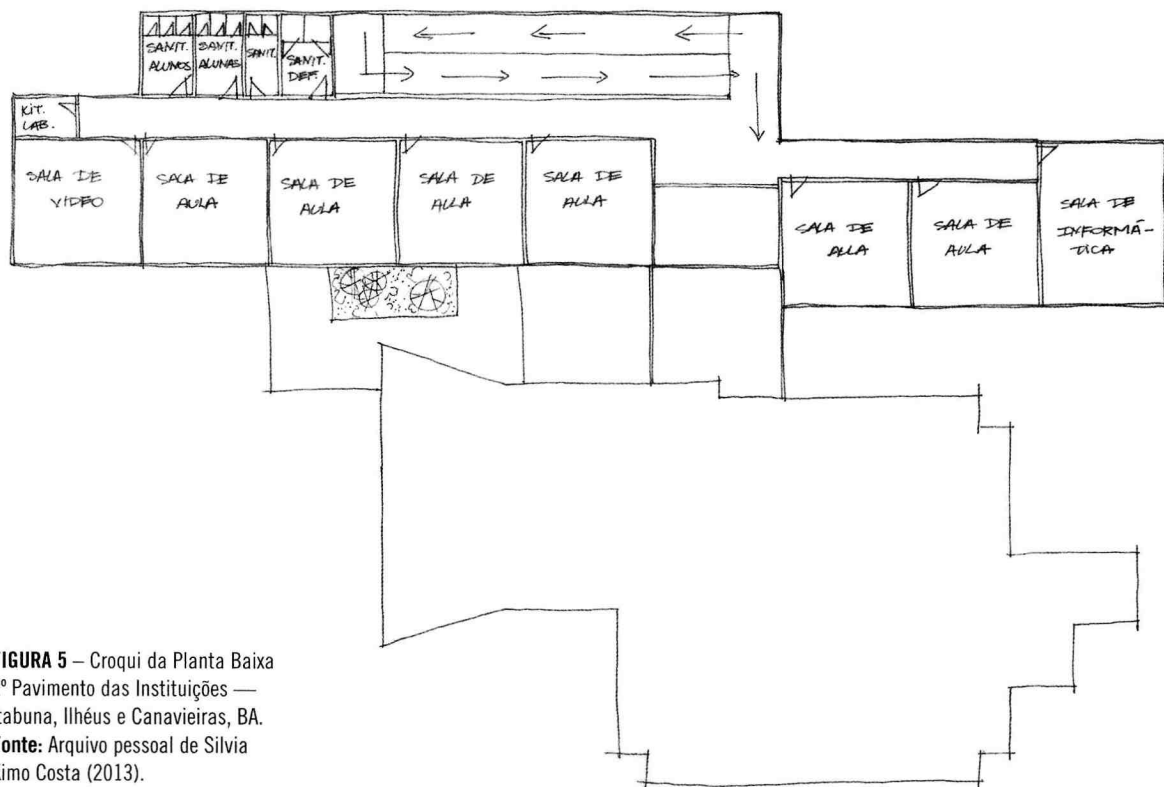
Croqui da Planta Baixa 2º Pavimento das Instituições — Itabuna, Ilhéus e Canavieiras, BA.
